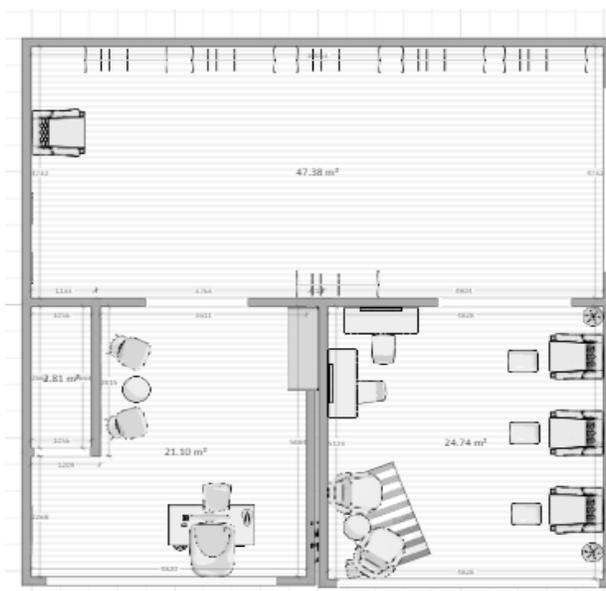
Distribución en planta piso 2. Fuente: Autores del proyecto
